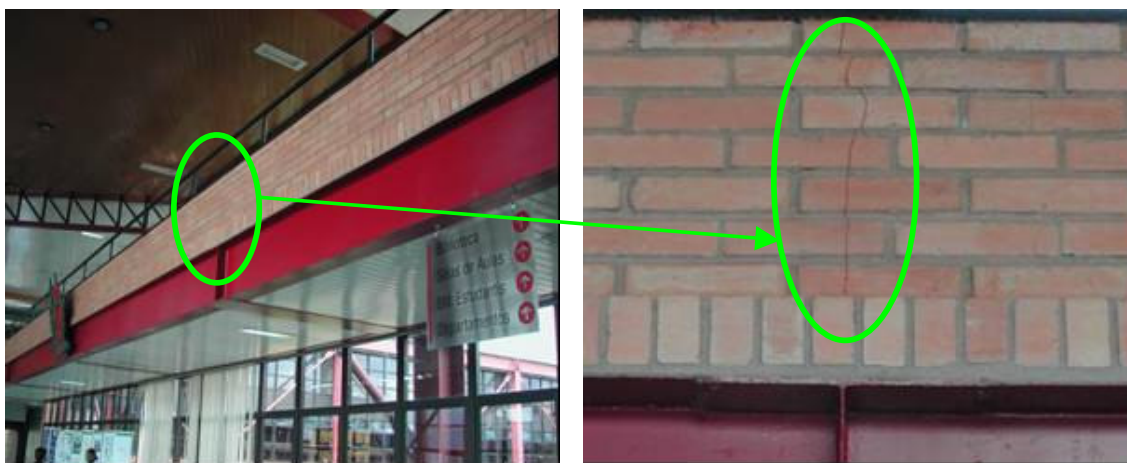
Trinca em fechamento sobre viga contínua apoiada em vigas em balanço
